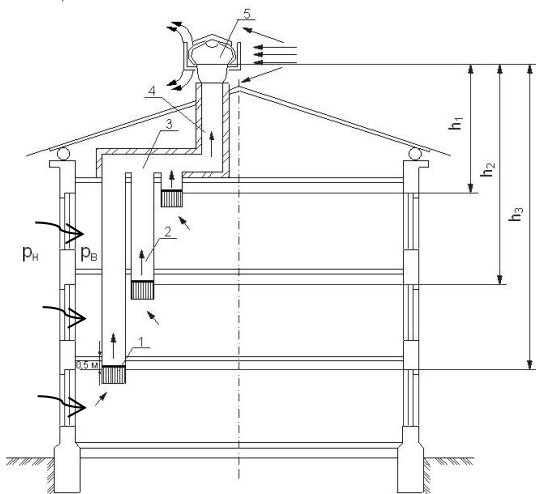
Канальная система естественной вытяжной вентиляции с неорганизованным притоком наружного воздуха через щели или специальные воздухоприточные устройства:
